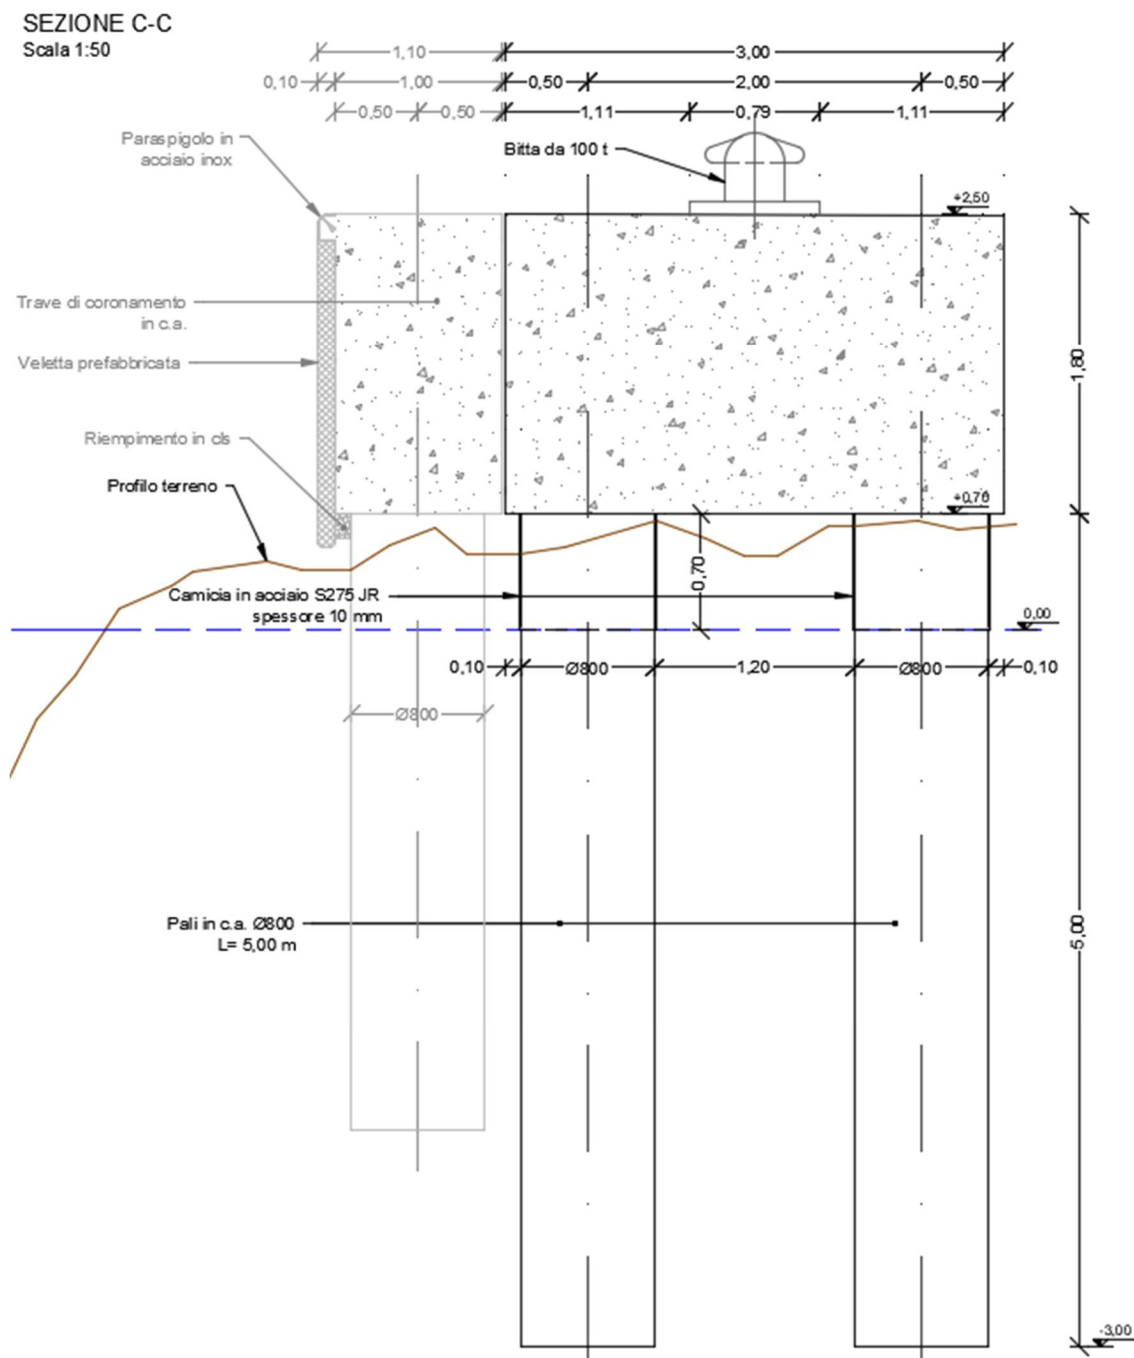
Ancoraggio bitta da 100 t alla radice, lato sud: sezione trasversale
